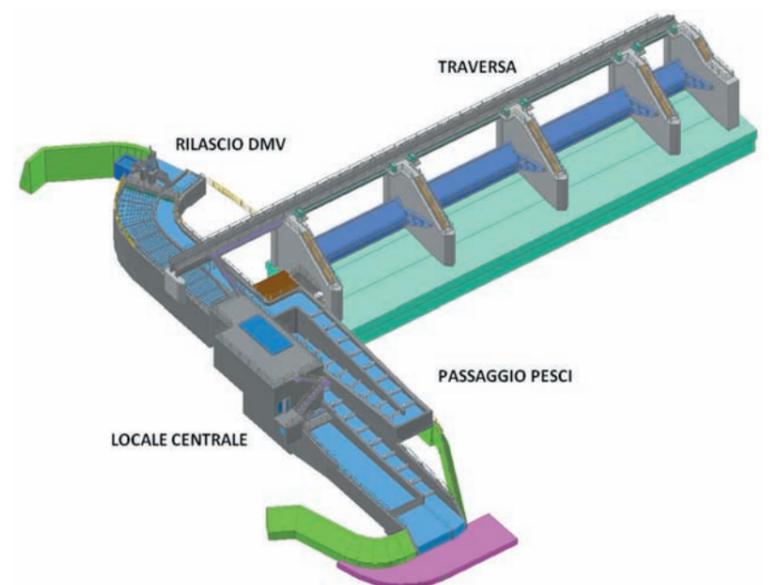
Costruzione 3D del modello strutturale delle opere.
